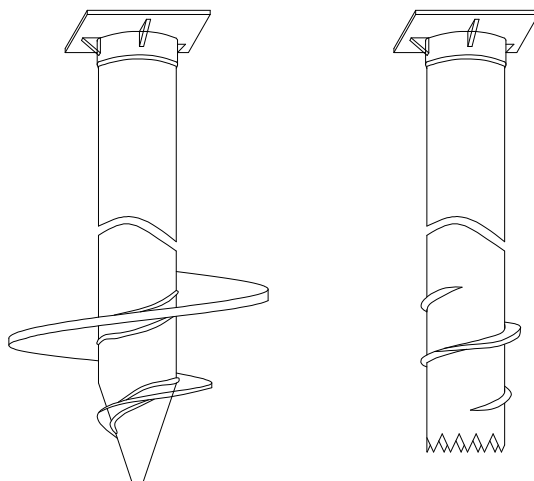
Винтовые сваи: а – для талых грунтов; б – для вечномерзлых грунтов.
